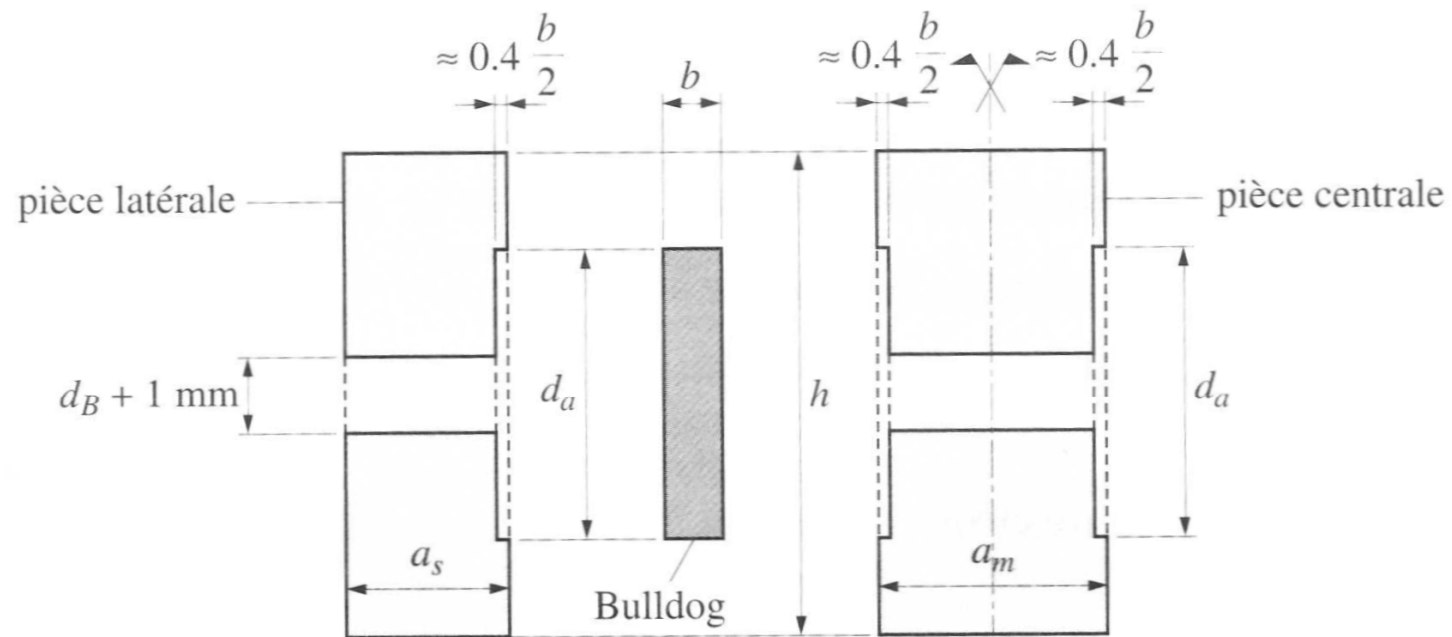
Section nette résultante pour un assemblage par Bulldog.
